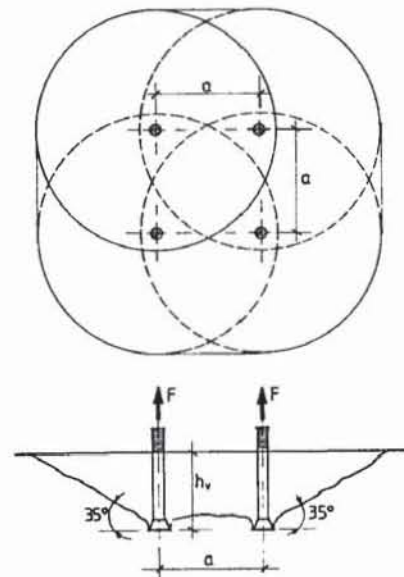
Gemeinsamer Betonausbruch bei einer Vierfachbefestigung
